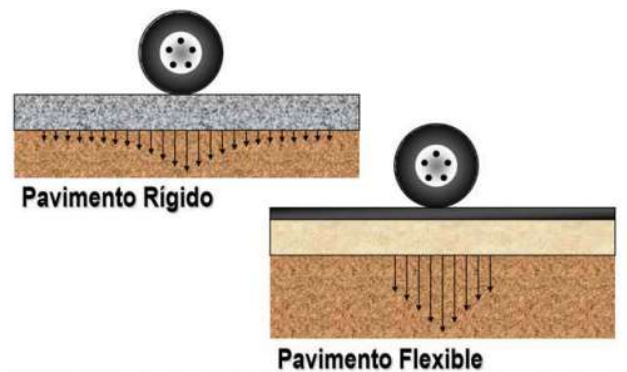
DISTRIBUCIÓN DE CARGAS EN PAVIMENTO RÍGIDO Y FLEXIBLE.
